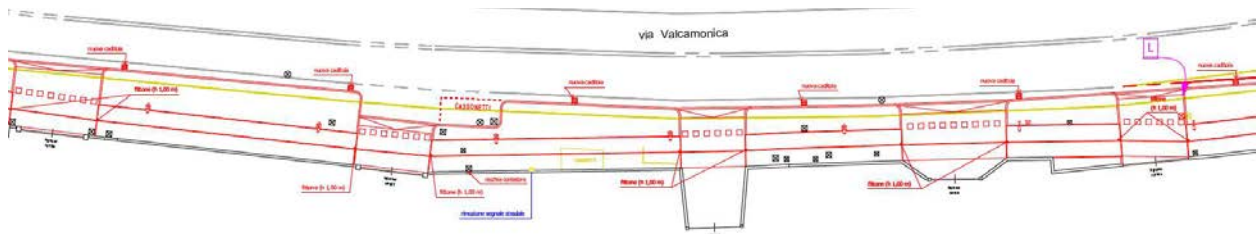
estratto Tav 6.7 - TRATTO IL
